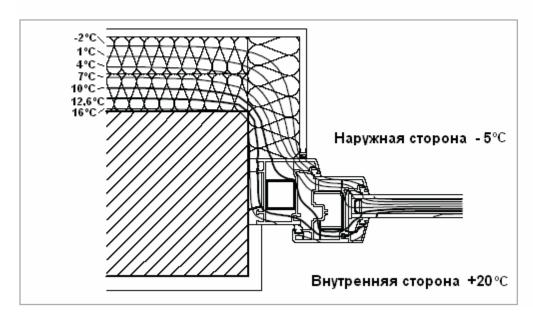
Бетонная стена с наружной изоляцией. Окно из профиля ПВХ, монтаж посредине, изоляция рамы.
